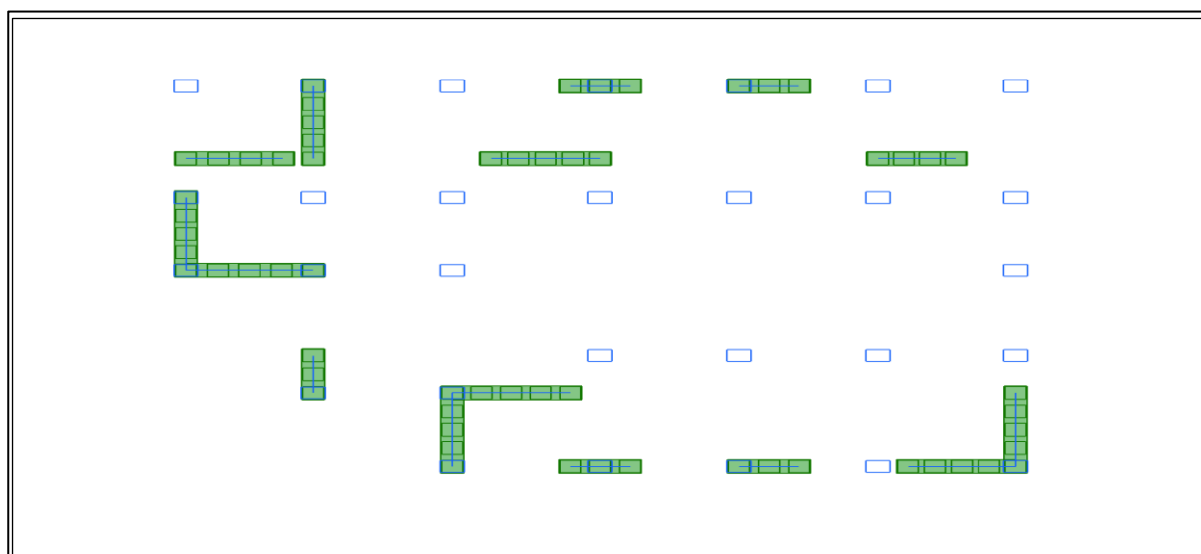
Vue en 2D et plan de la 1^{ère} proposition.
